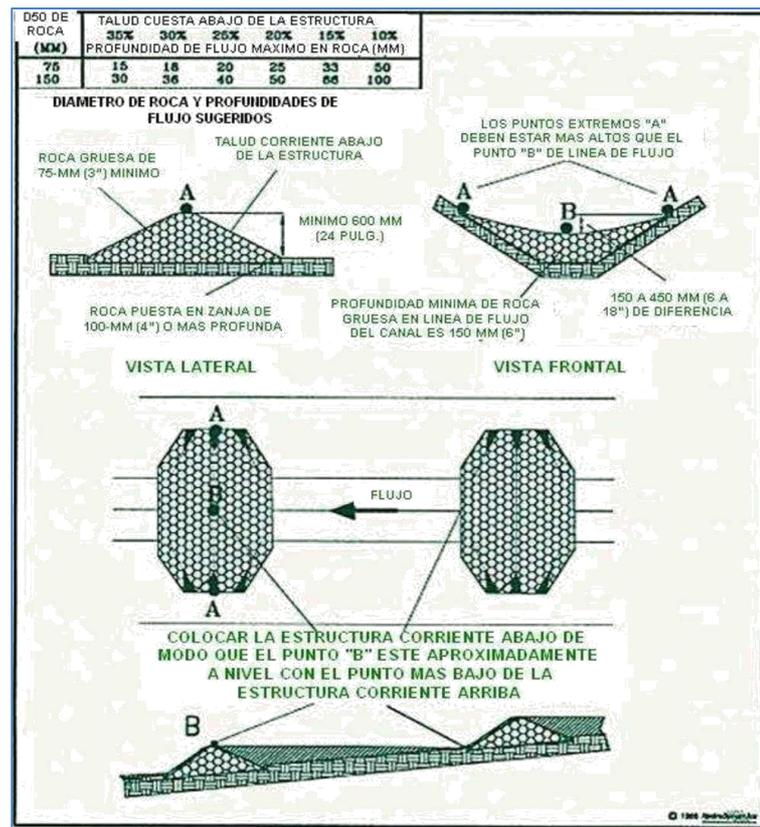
Ilustración de una estructura de retención de roca debidamente instalada
